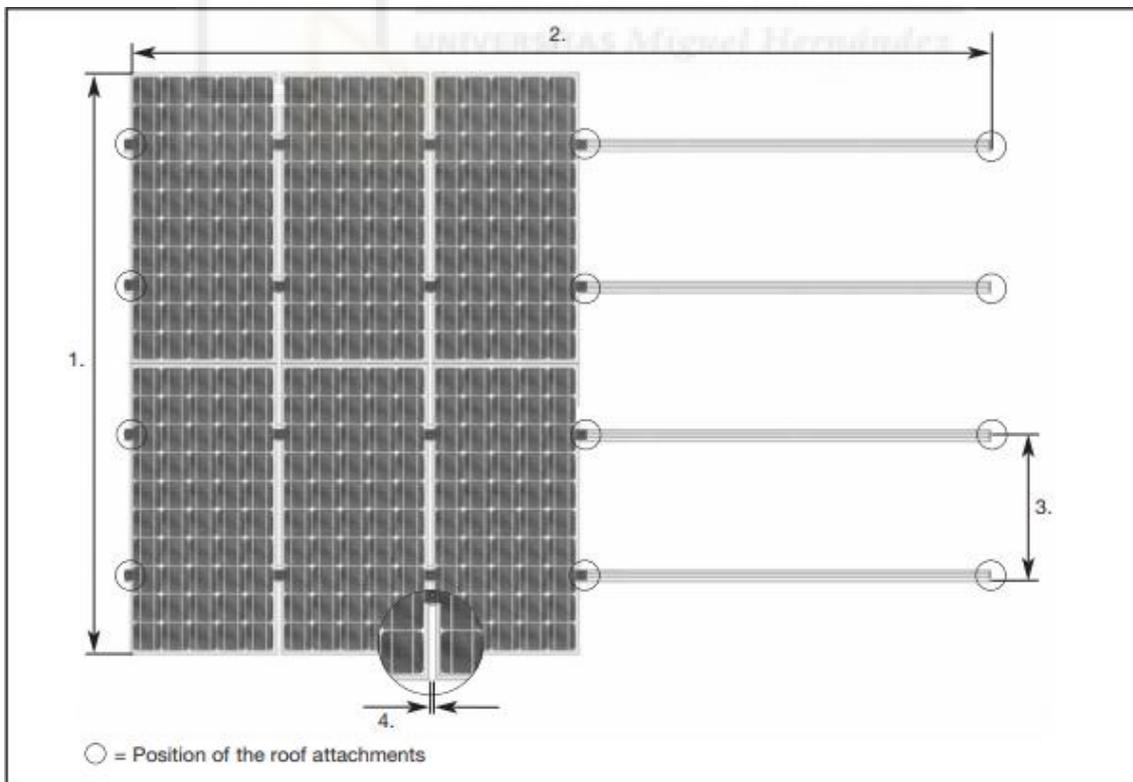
Ejemplo de configuración de módulos sobre la estructura
